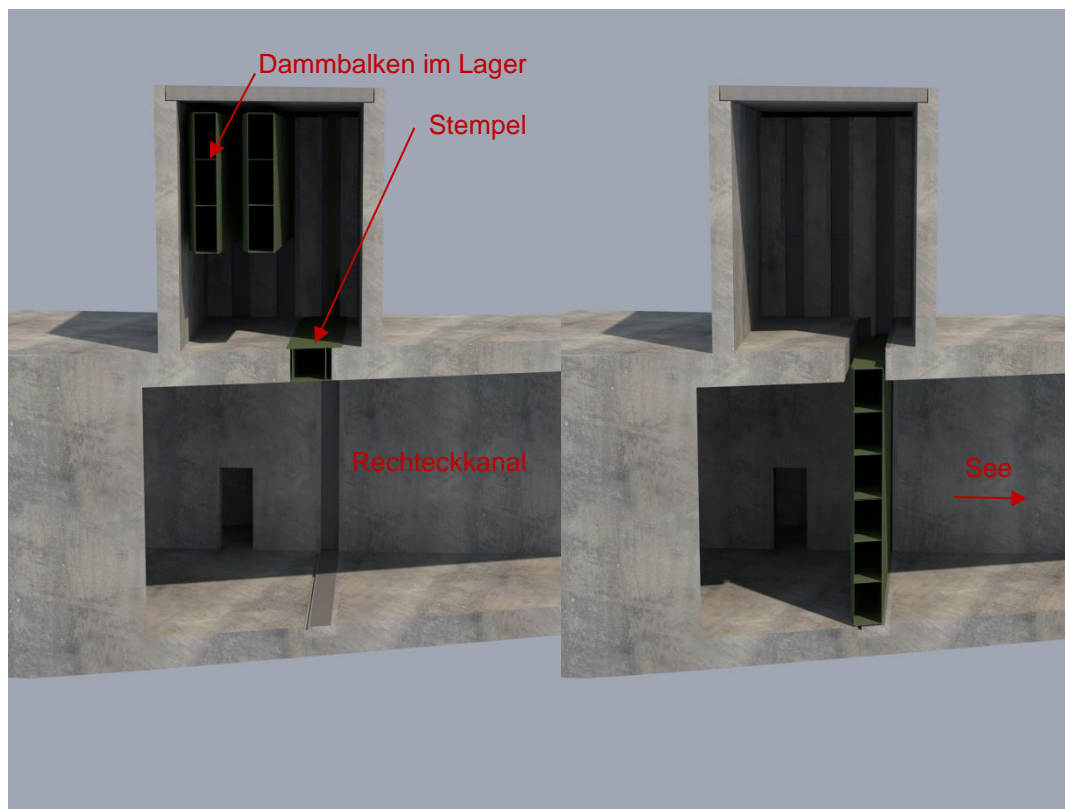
Schnitt durch Dammbalkenschacht und Revisionszugang, Dammbalken in Lagerposition (links) und Dammbalken eingesetzt (rechts)
